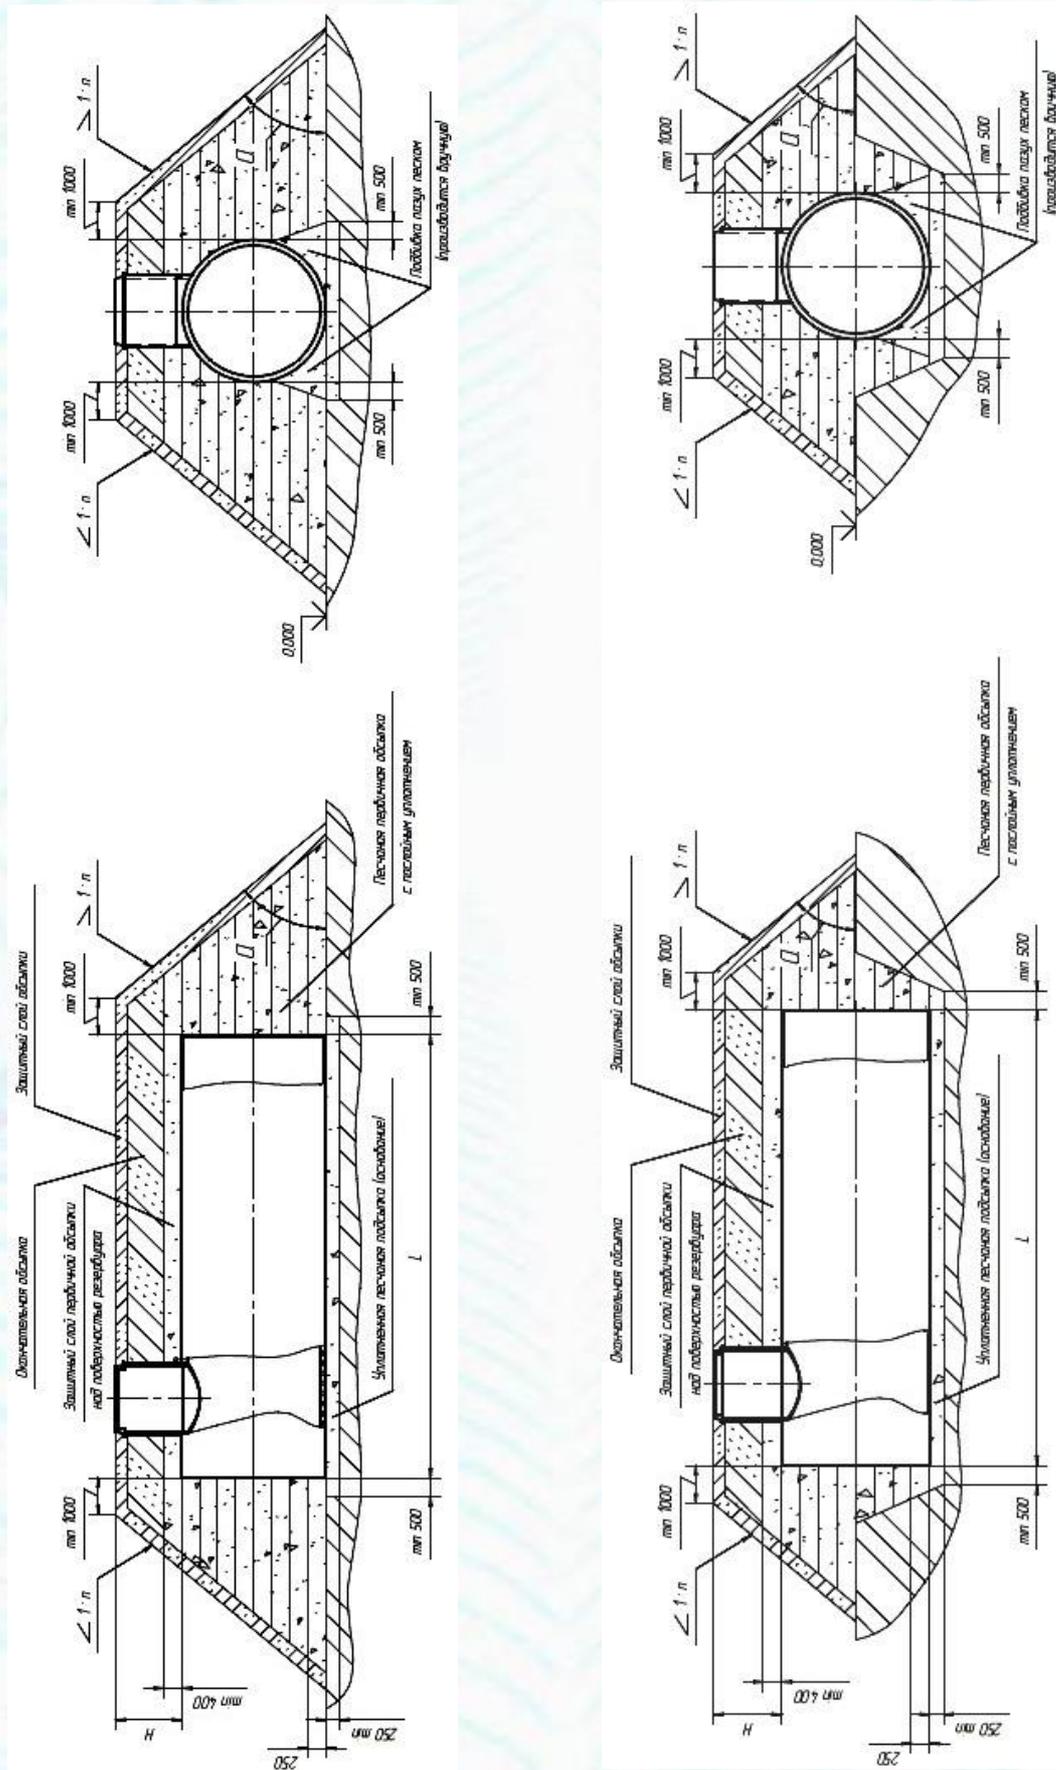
Схемы монтажа резервуара в насыпи на песчаном основании
